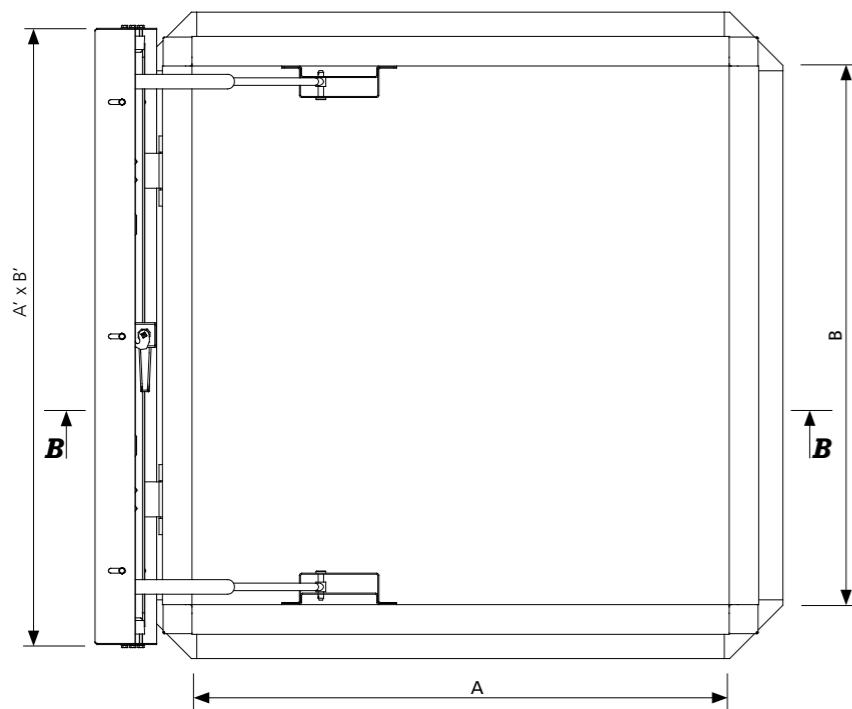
Draufsicht von einem Dachausstieg mcr PROLIGHT Typ C in geöffneter Position, Maße in [mm]
